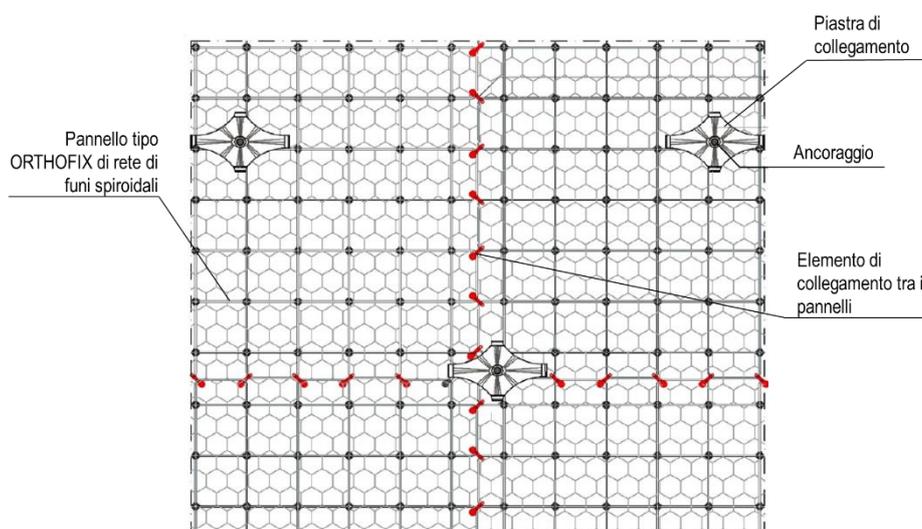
Schema dei pannelli di rete tipo ORTHOFIX con rete doppia torsione accoppiata e barre di ancoraggio.
